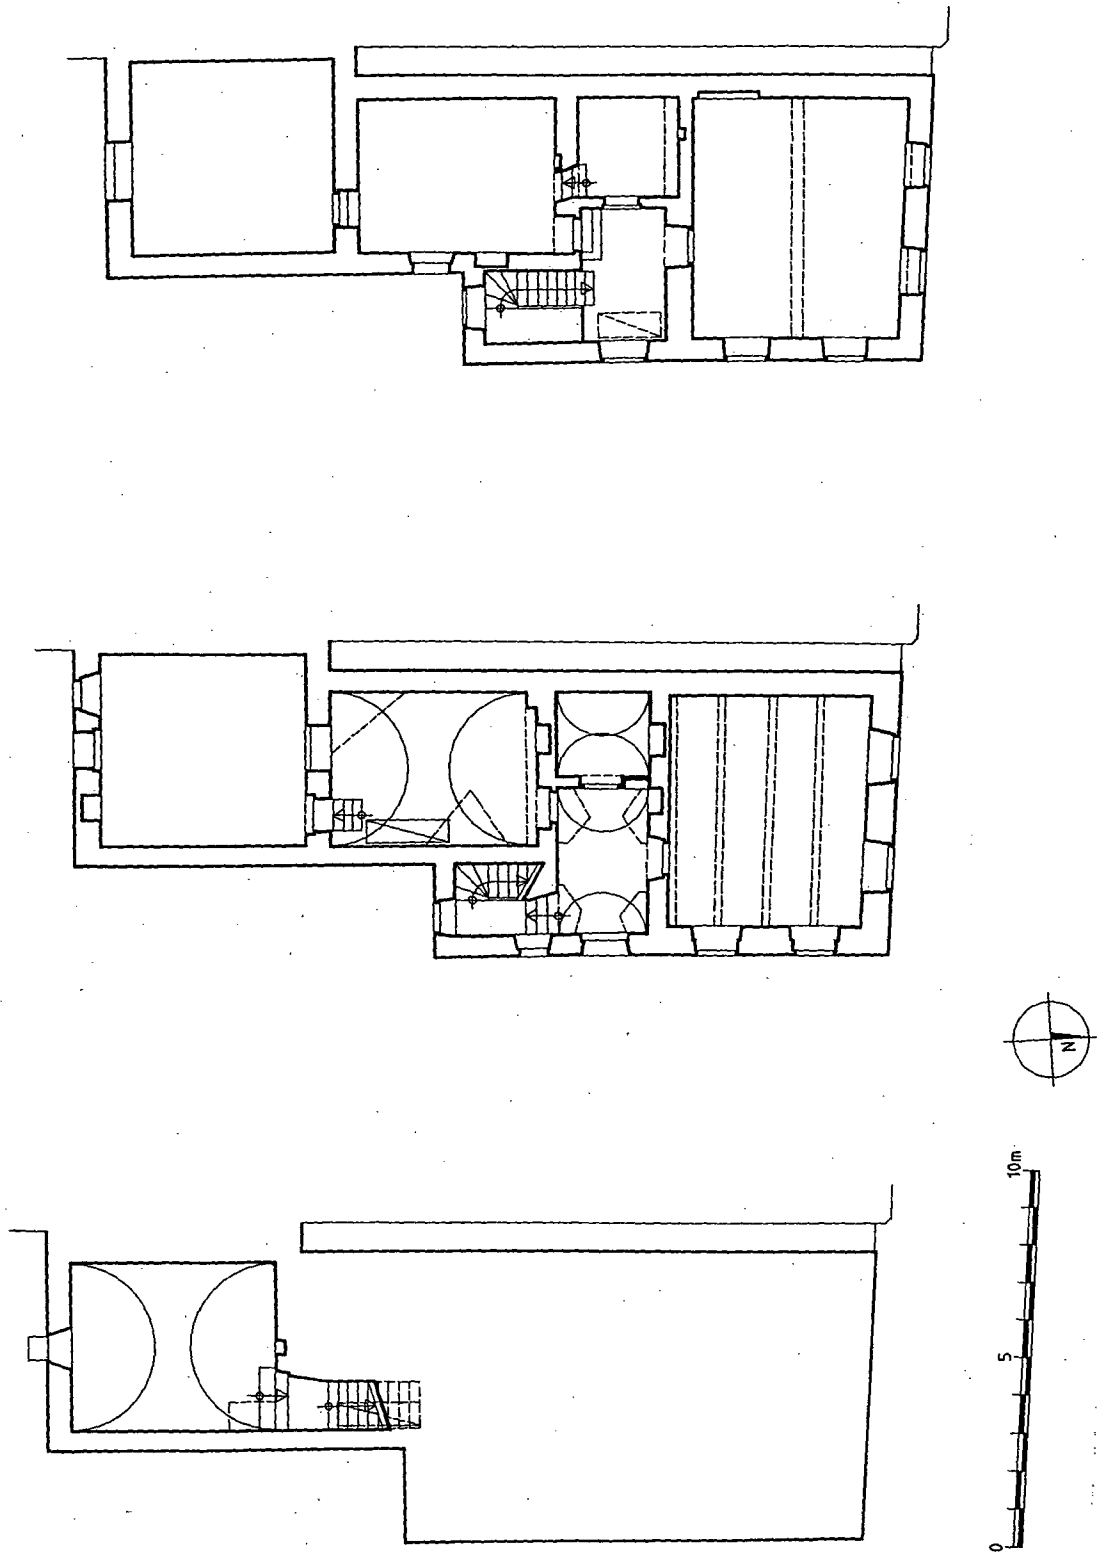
Schiferplatz 2 – Grundrisse Keller, Erdgeschoss, Obergeschoss (1:200).
